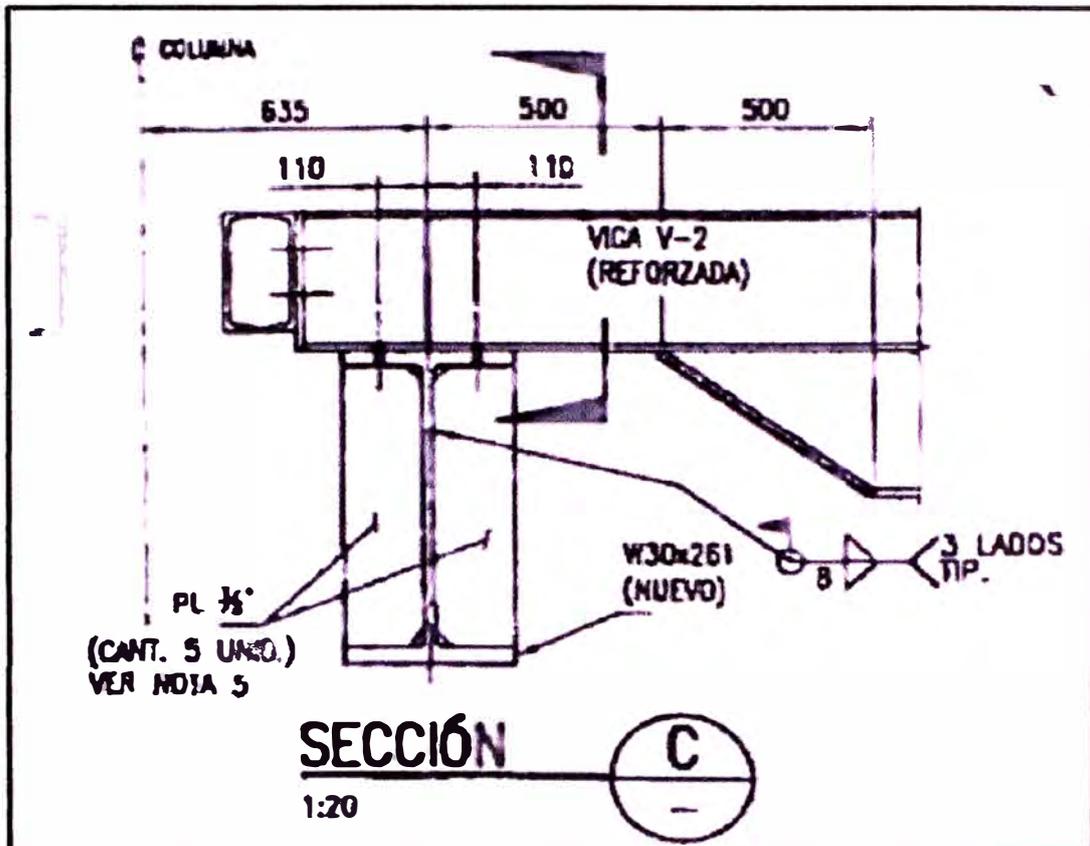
Detalle de unión entre viga W30x261 y viga V-2
